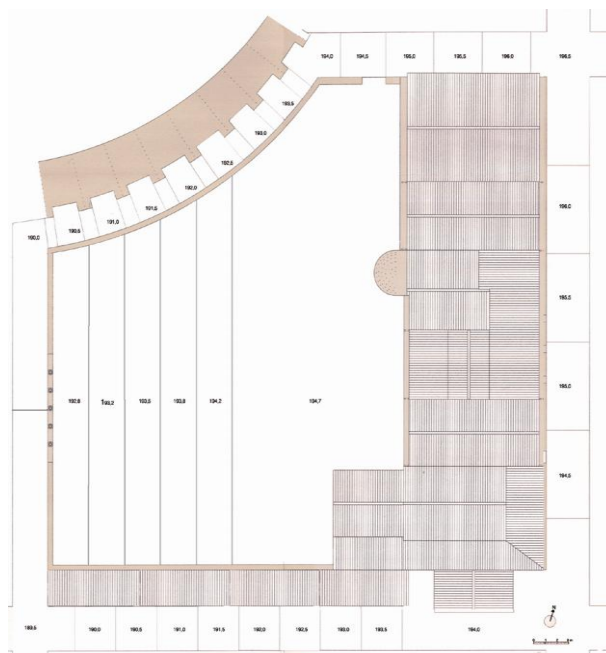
Planta do exterior das Termas do Alto da Cividade.
